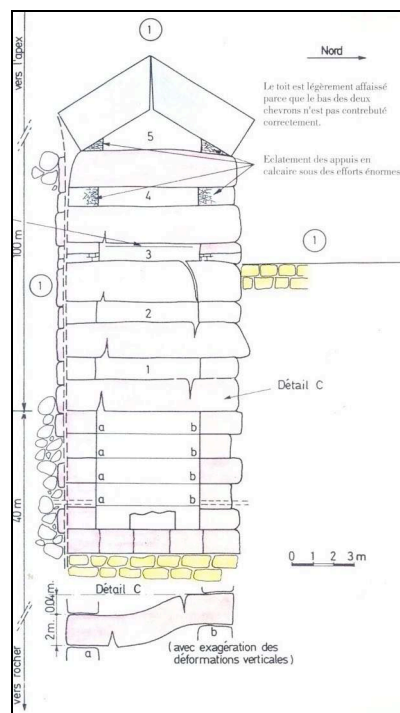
Les poutres de rehausse sont fissurées, d'après Kérisel (1991)
